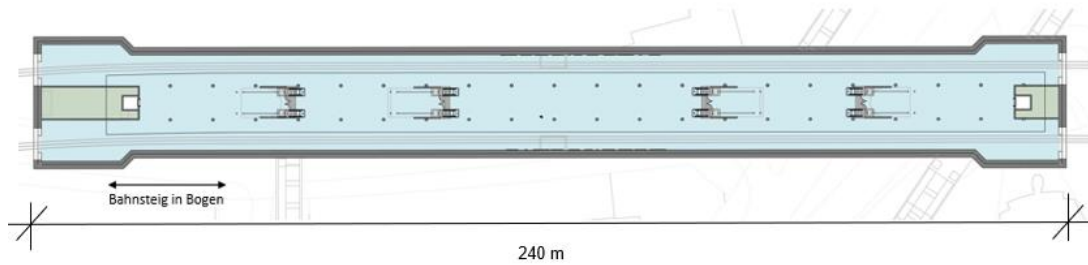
Hp Alsenplatz Var. II – Grundrisse
